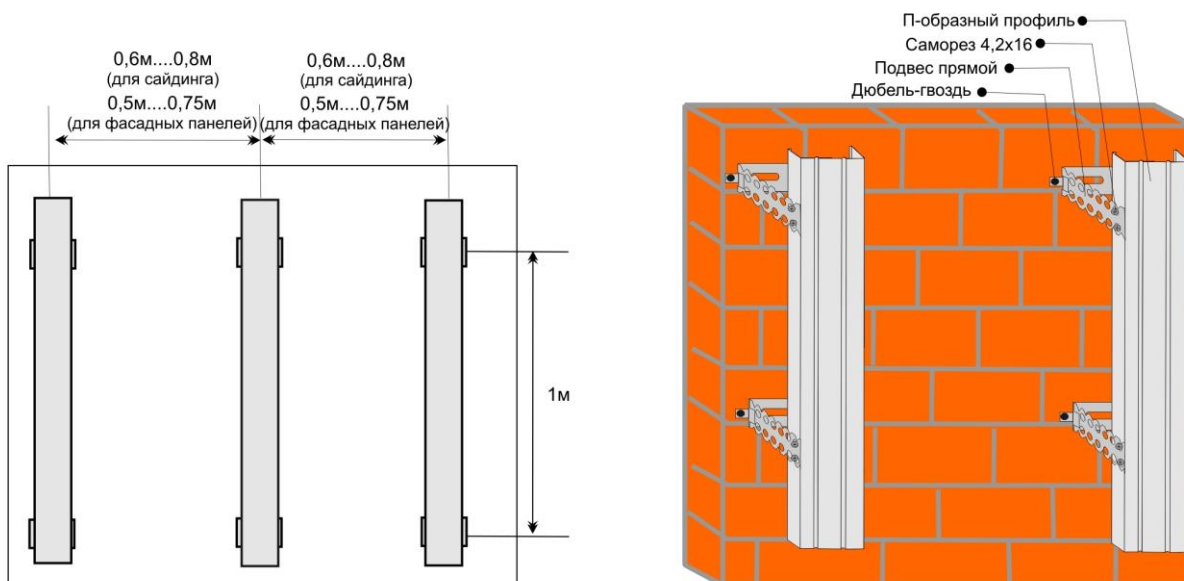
Горизонтальный монтаж сайдинга и фасадных панелей
